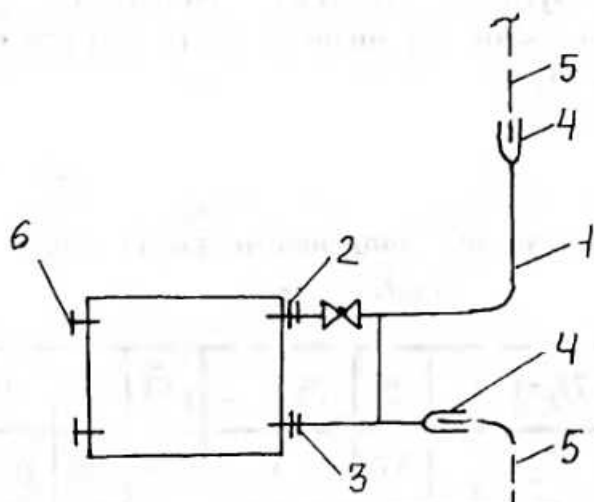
Схема приєднання трубного вузла до чавунного радіатора: 1 - трубний вузол; 2 - прохідна радіаторна пробка; 3 - контргайка; 4 - компенсаційний розтруб (стаканчик); 5 - поверхостояк; 6-заглушка
